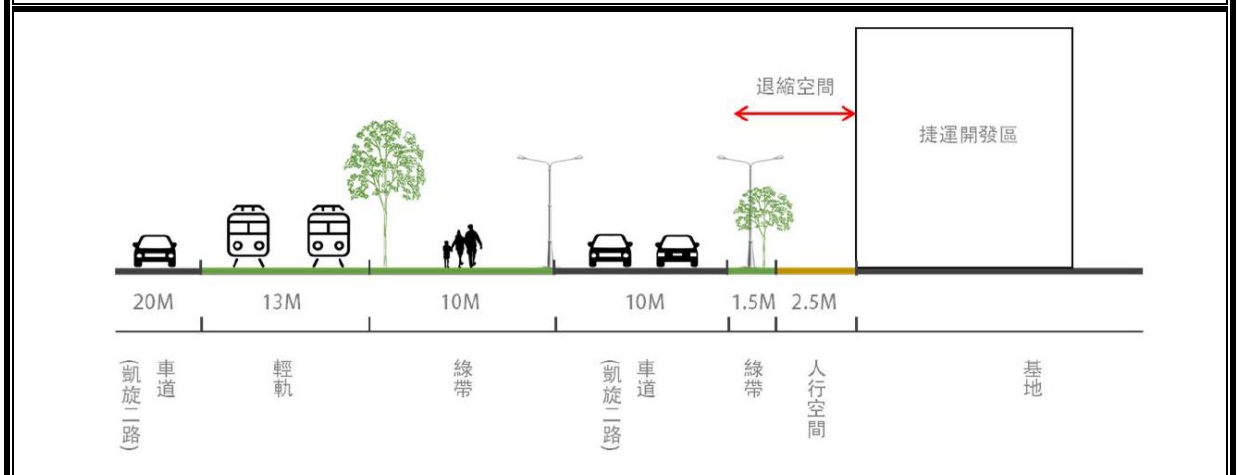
臨凱旋二路側道路斷面示意圖
